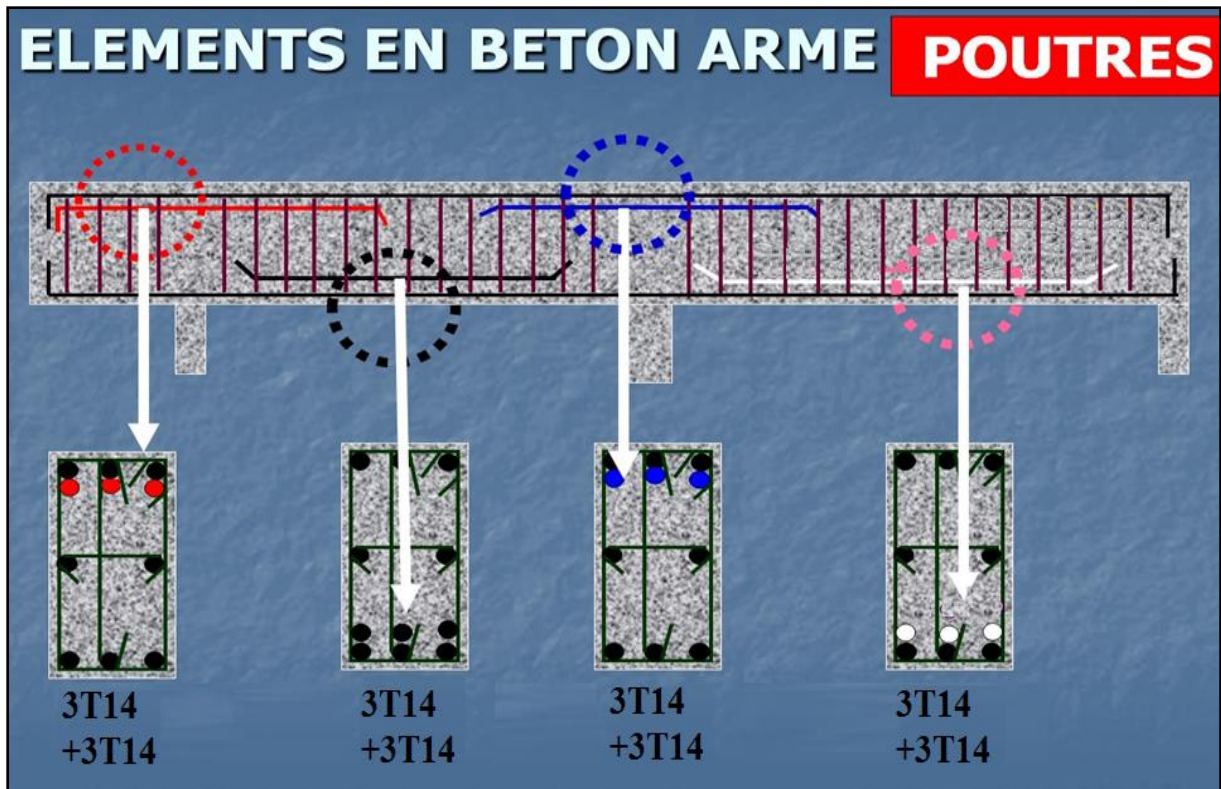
Ferrailage des poutres principales du bloc A2, B1 et B2 de siège APC.
